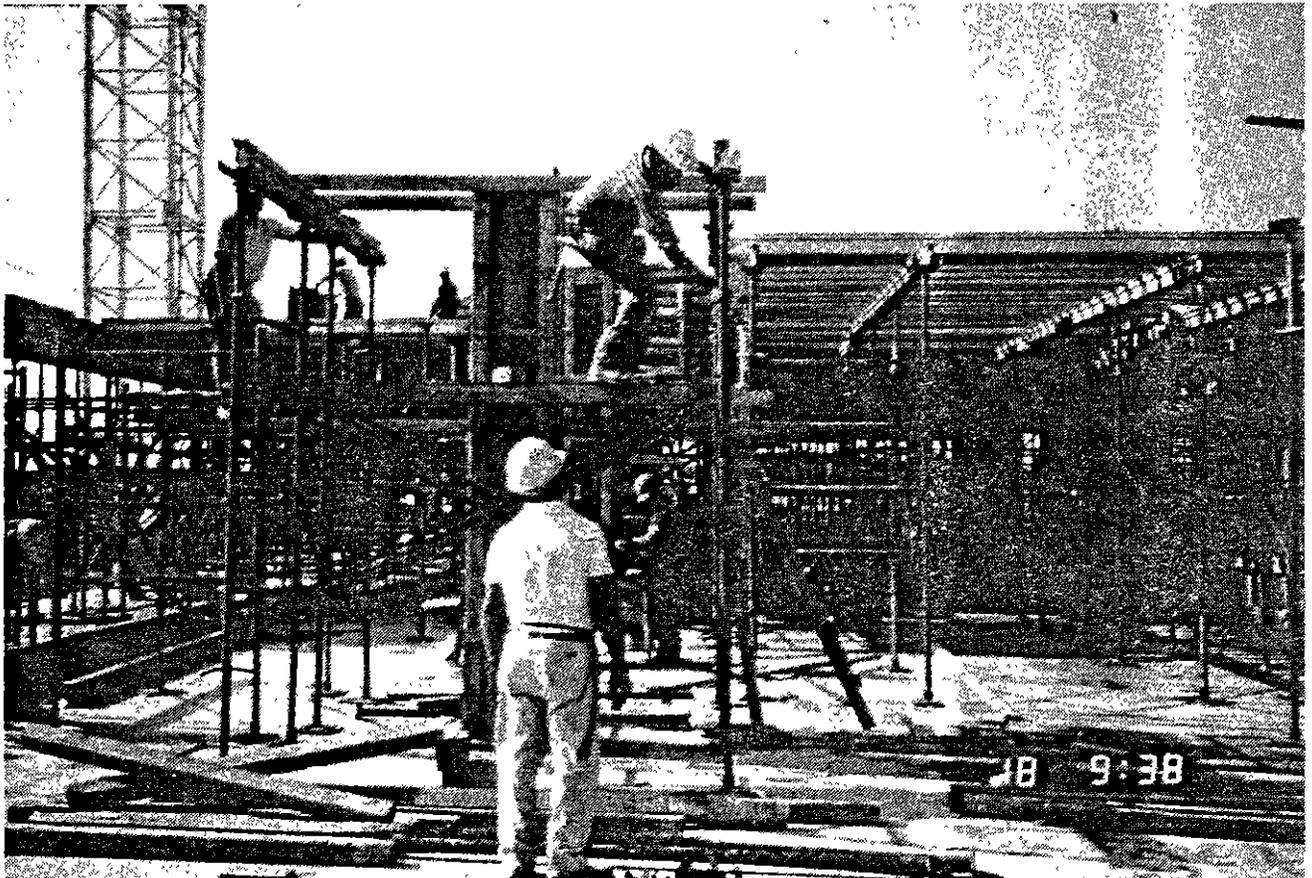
MONTAGE DE LA STRUCTURE PORTANTE
